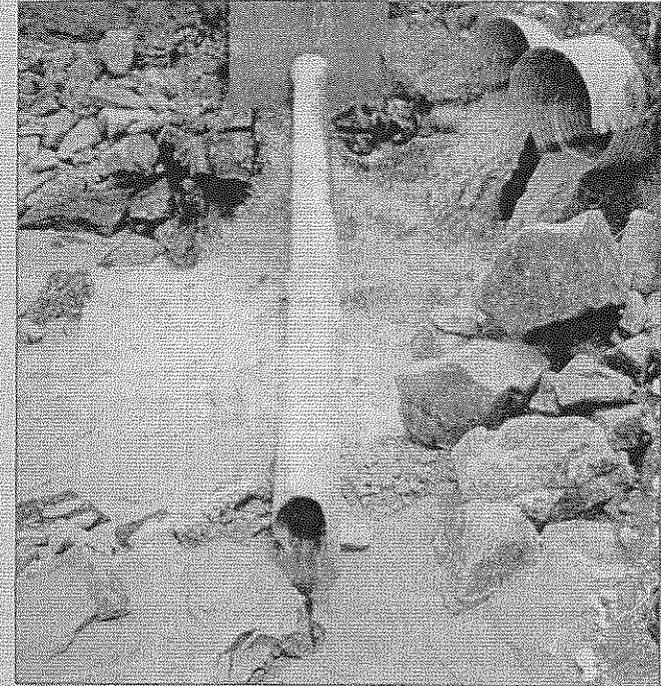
Sistema de alcantarillado roto por deslizamientos de tierra
